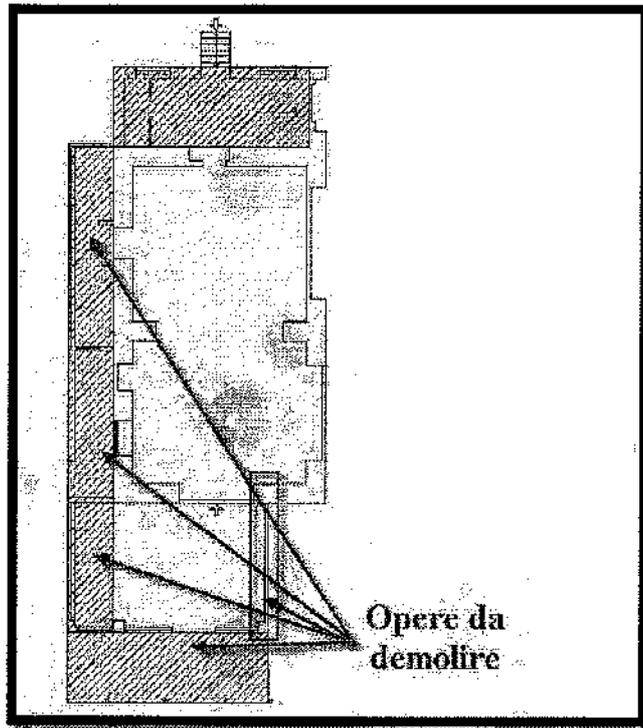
Pianta piano terra (sub 1) - Abusi non sanabili
